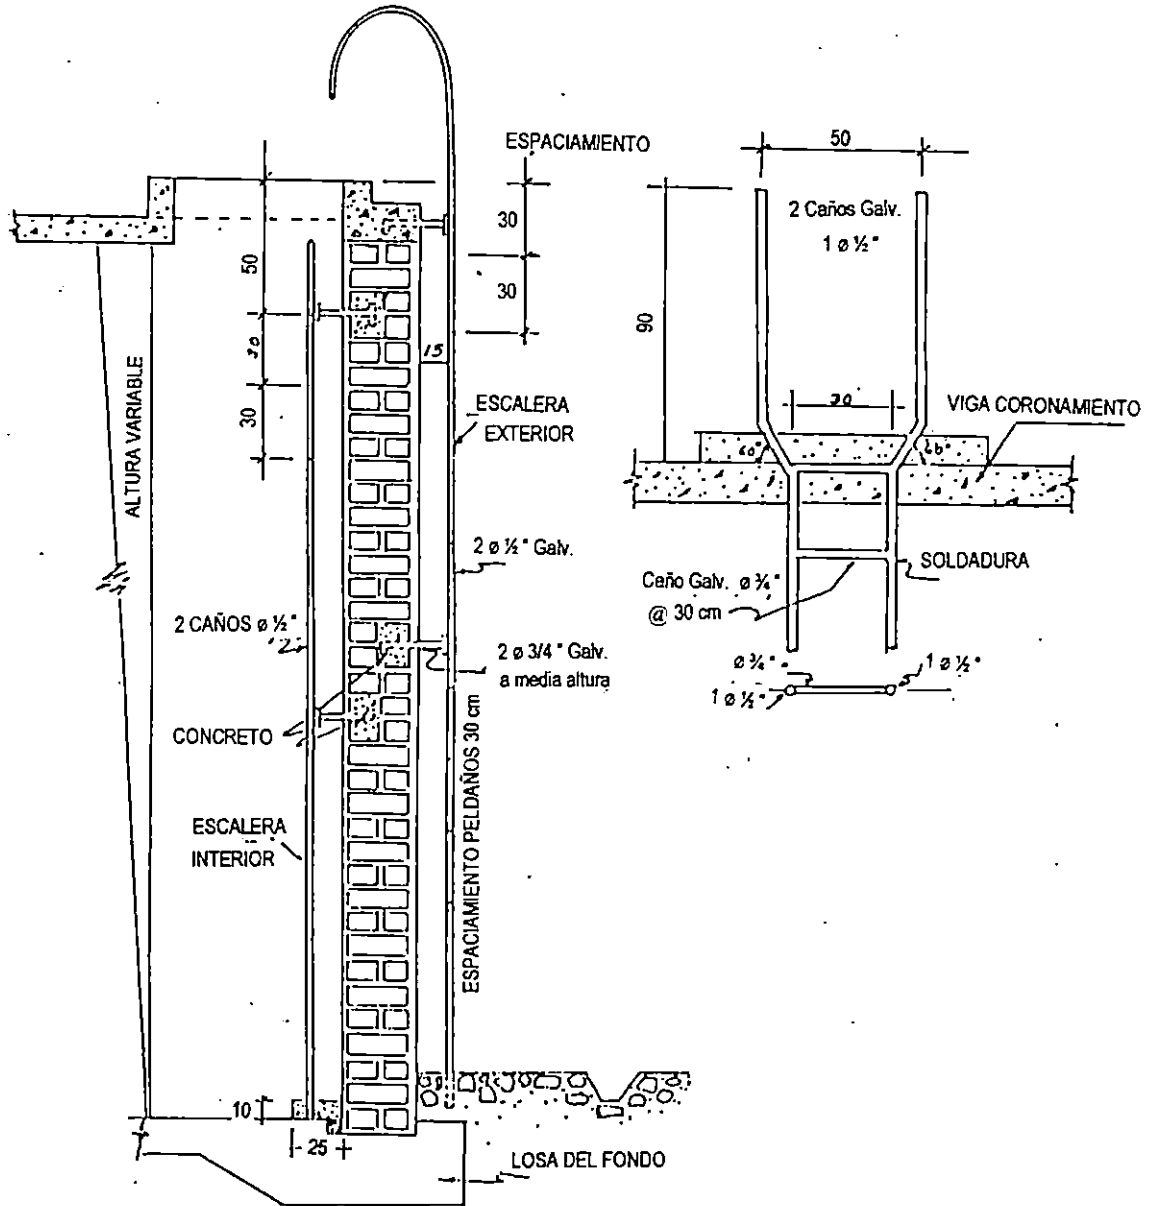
Detalle de Escaleras de Inspección en Tanques
